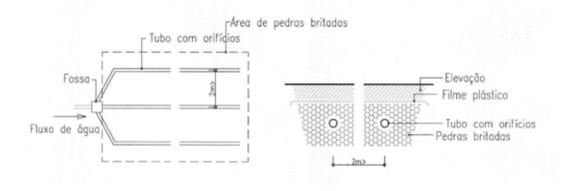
Estrutura da Área de Infiltração (esquerda: Plano, direita: Imagem transversal)
